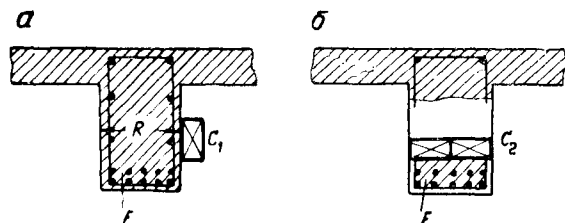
Раздельное (последовательное) подрывание бетона и арматуры:
